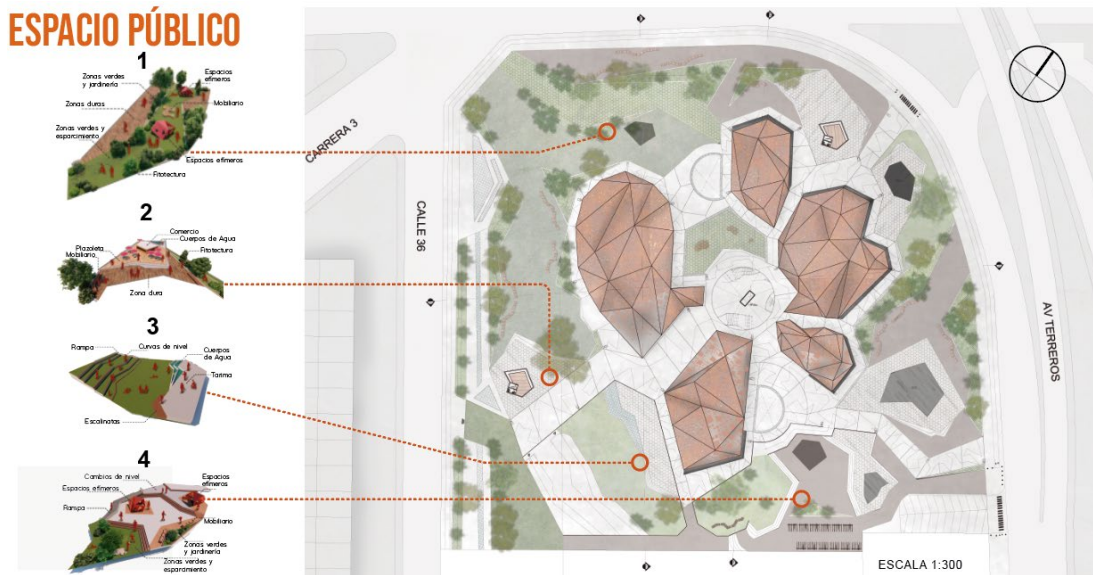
Plano de cubiertas y espacio público junto con cortes urbanos. Elaboración propia.
